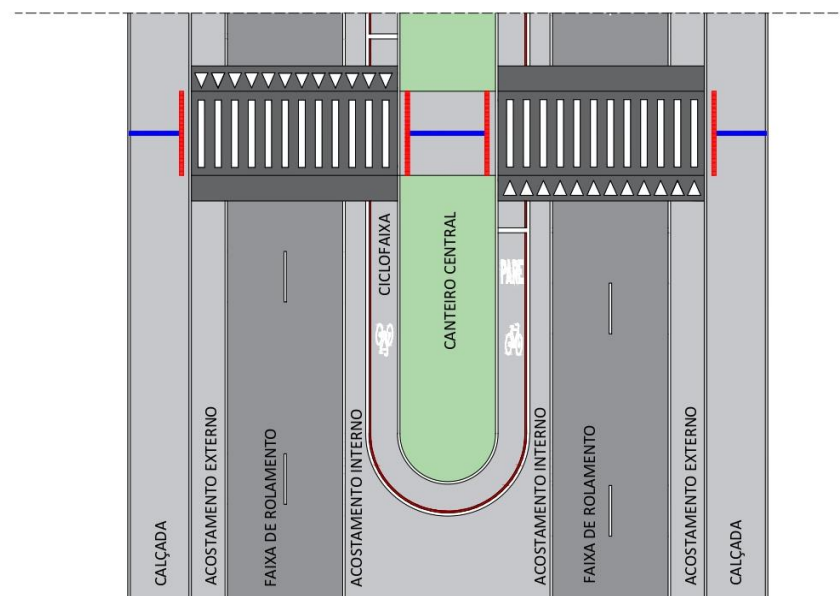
Vista superior de trecho da rodovia BR-304 (sem escala)
